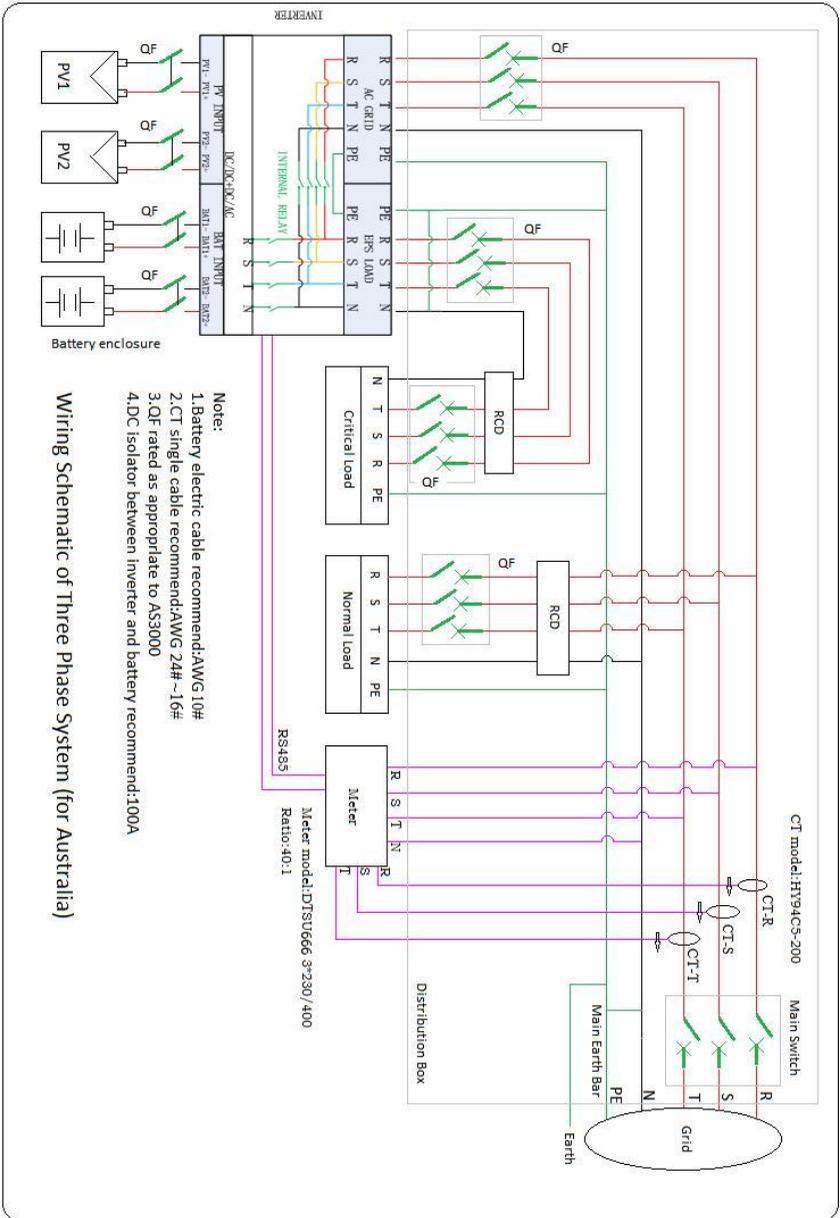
Conexiones eléctricas (Plan B:Contador +CT)
